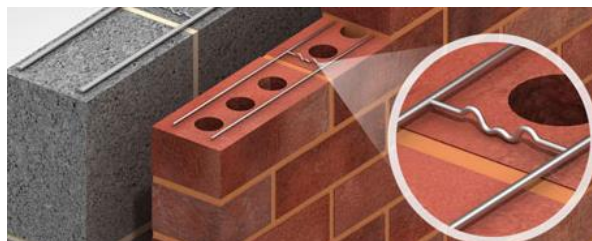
2 - Exemplo de armadura de aço na junta de assentamento (Ancon, 2016)
